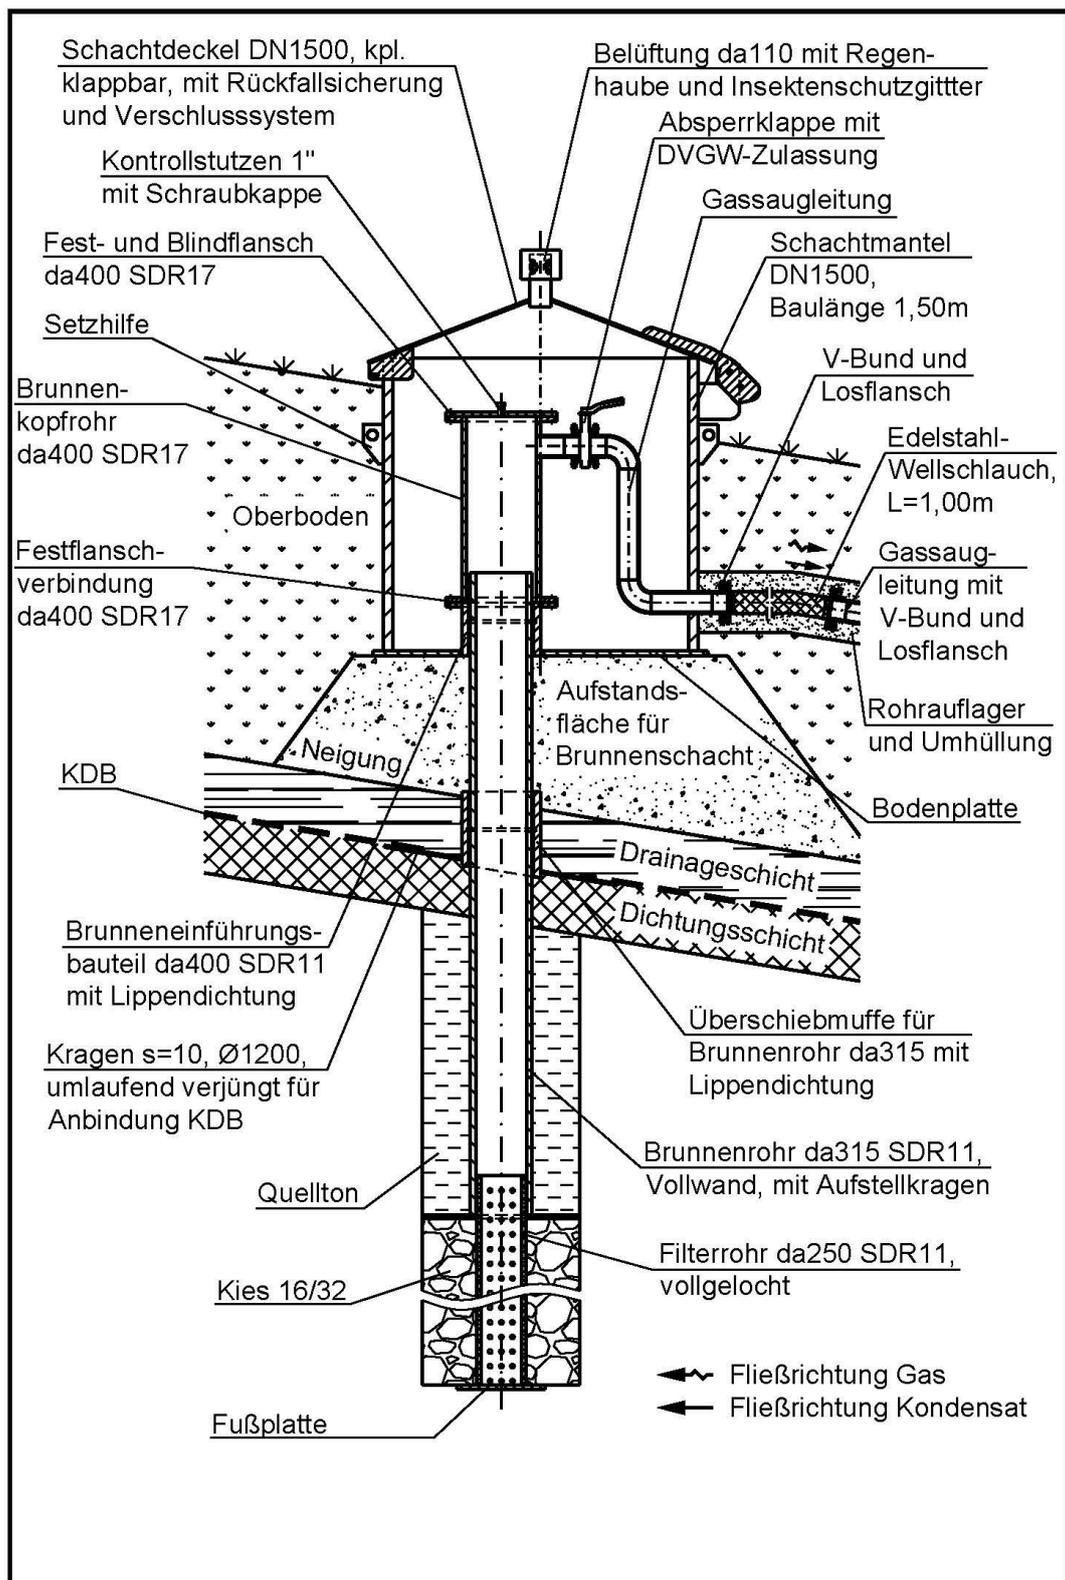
Gasbrunnensystem – Ausführungsbeispiel teleskopierbare Brunnenkopfausführung
